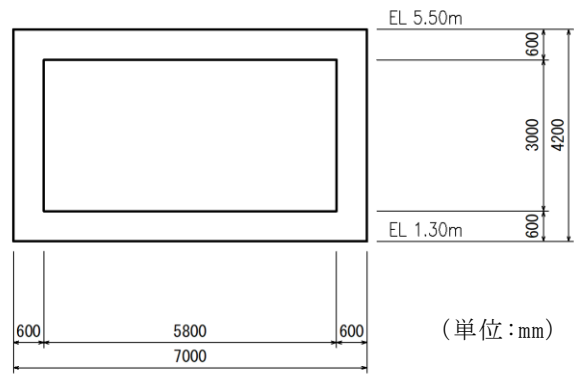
屋外配管ダクト (タービン建物～放水槽) 断面図 (A-A 断面)
